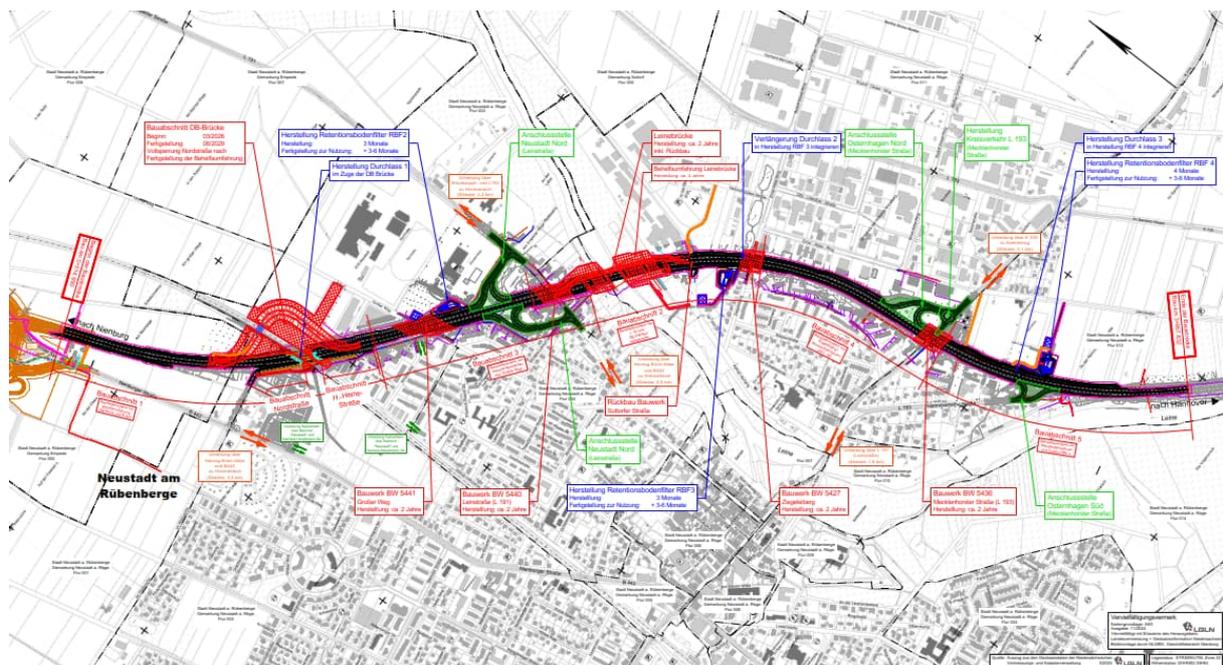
Darstellung Bauabschnitte im Übersichtslegeplan
